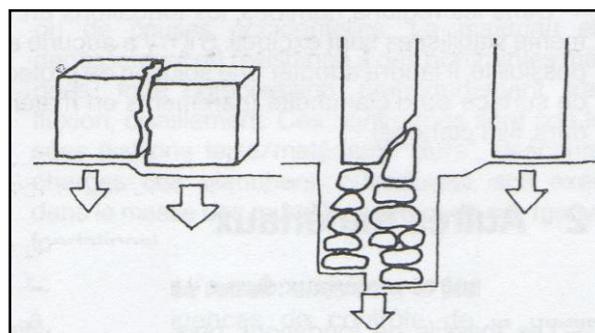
tassement différentiel engendrant la déstabilisation de la fondation
